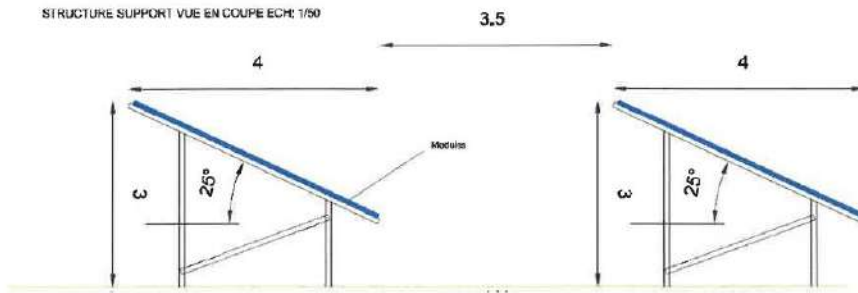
Plan en coupe des structures support extrait du dossier de PC du projet de Volx
